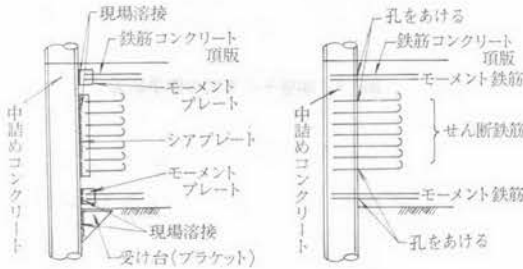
頂版と鋼管矢板の結合部の構造例（現場溶接による方法）
